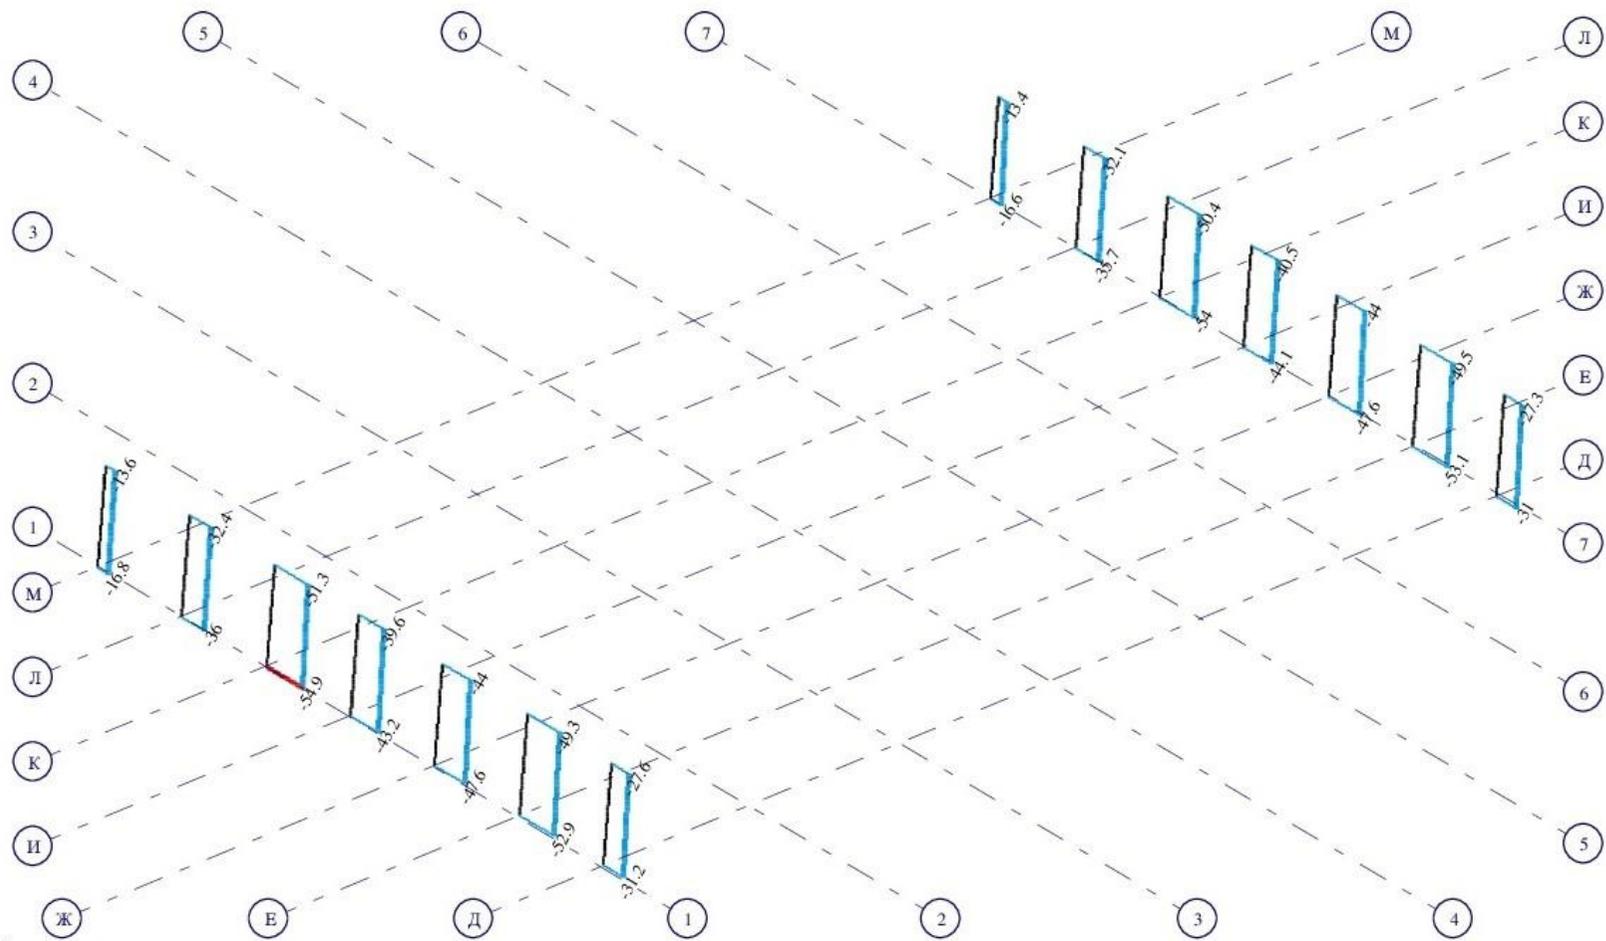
Схема нагрузок N на фундаменты манеж
